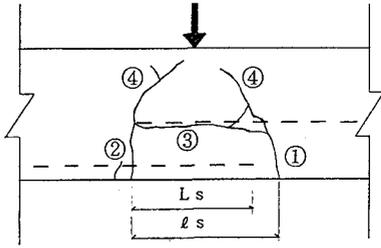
破壊形状 (①~④の順にひび割れ発生)
